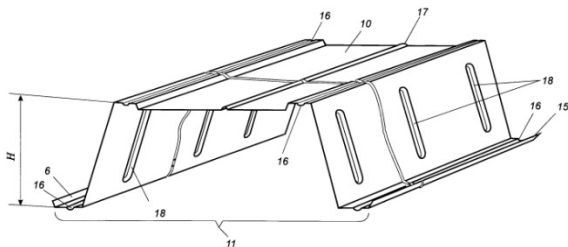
Опалубочный элемент несъемной опалубки большепролетного перекрытия [3-5], где: 6 – стенка двутавровой балки; 10 – плоскость верхнего основания; 11 – плоскость нижнего основания; 15 – отбортовка; 16 – продольные канавки жёсткости; 17 – дополнительная продольная канавка жёсткости; 18 – поперечные рёбра жёсткости; H – высота.
